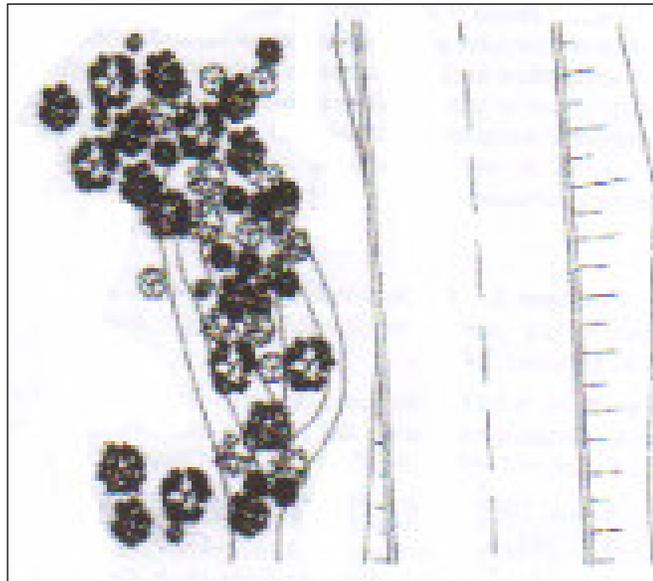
Occupazione planimetrica di una fascia marginale protettiva
